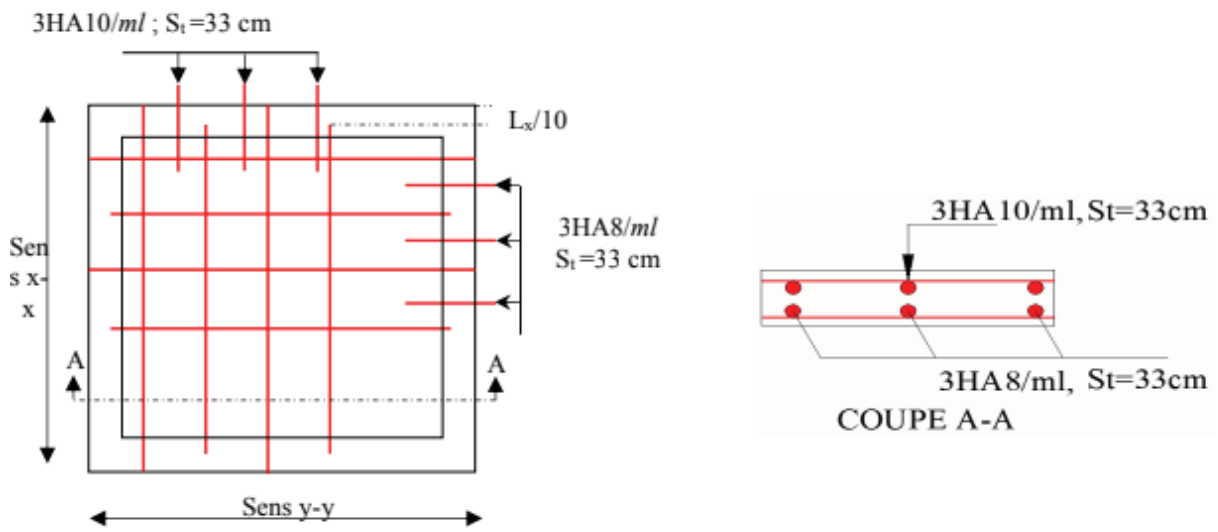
Schémas de ferrailage de la dalle pleine
